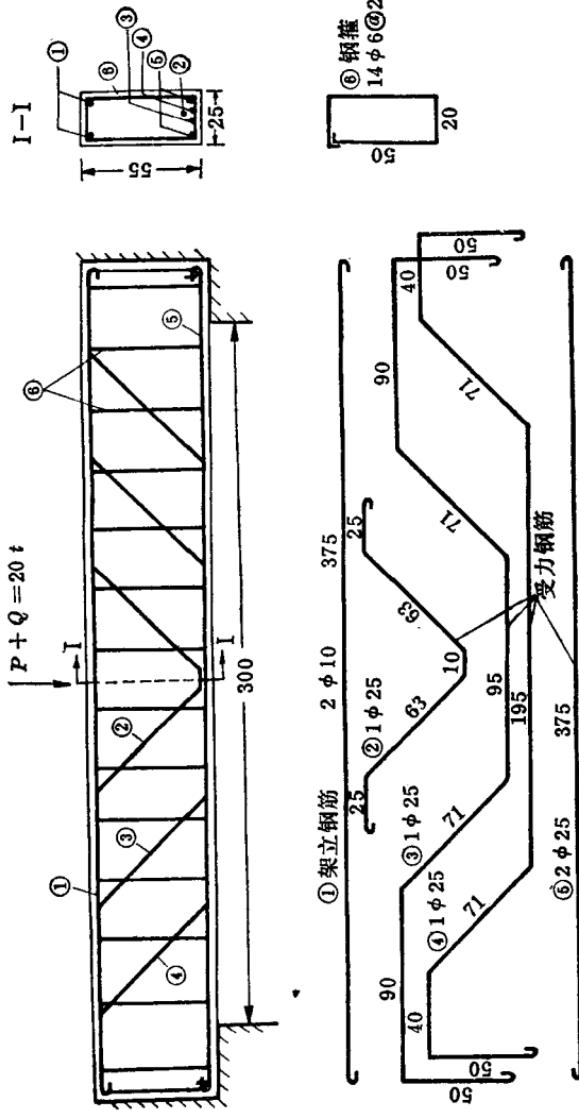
钢筋混凝土梁的受力钢筋、架立钢筋和钢箍
